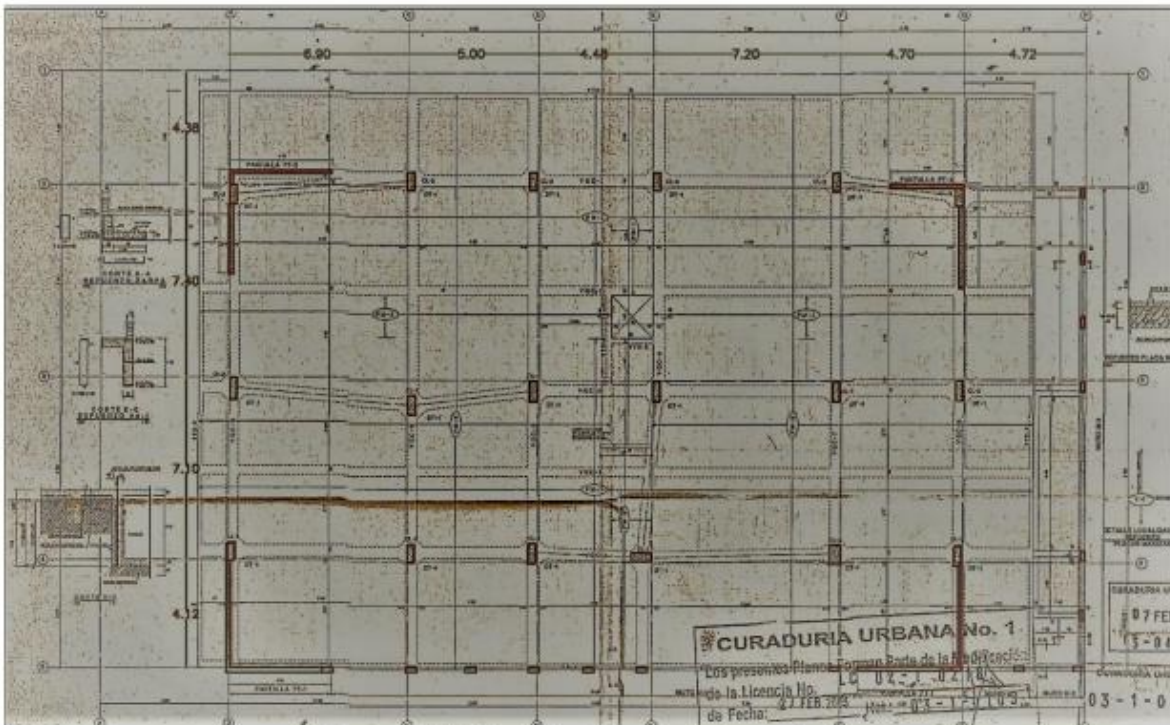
Plano de Cimentación, Elaborado en 2003 por el Ingeniero Juan Tamasco. Proyecto estructural
